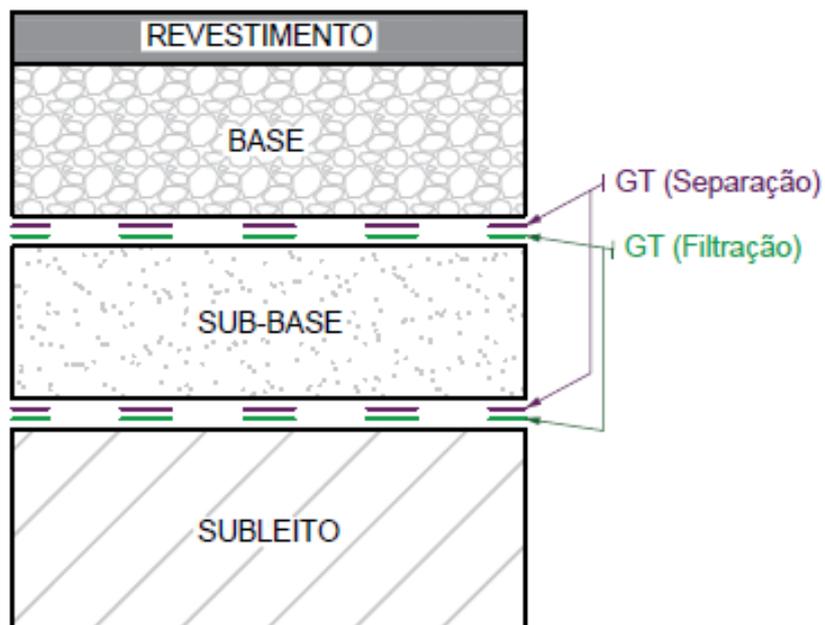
Soluções em geossintéticos para o enrijecimento do pavimento.
